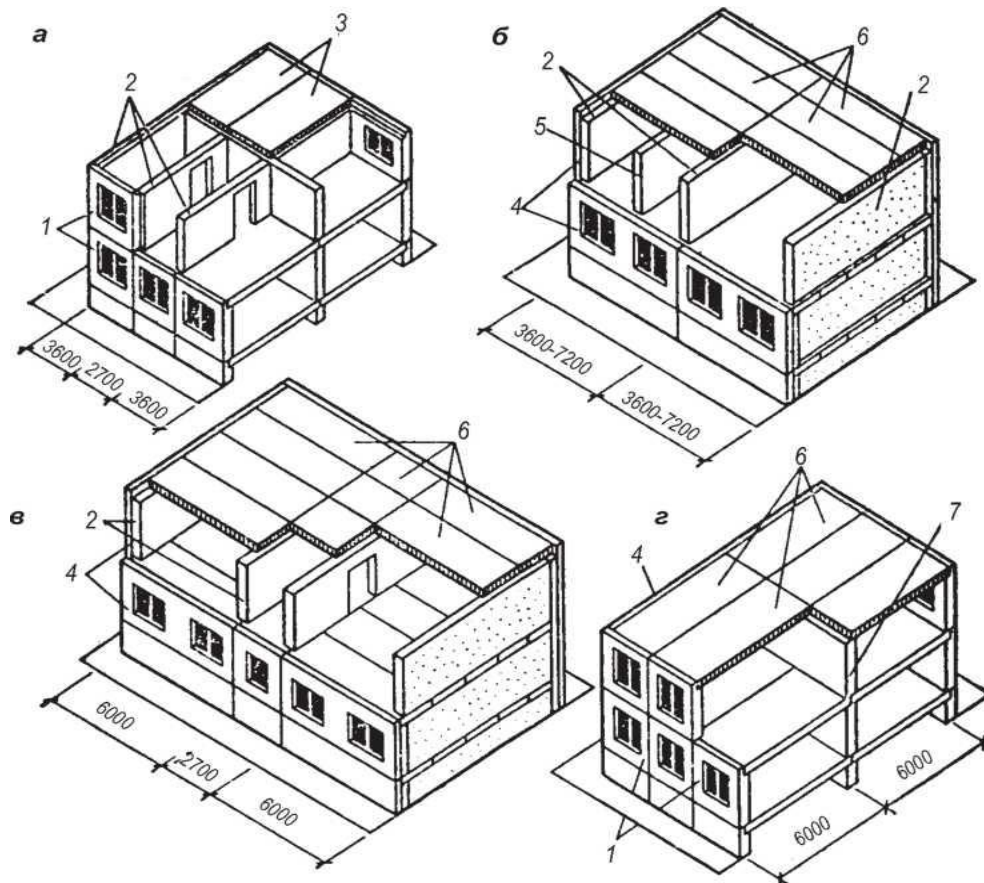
Конструктивні схеми безкаркасних великопанельних будівель: а – з малим кроком несучих поперечних стін; б – з великим кроком несучих поперечних стін; в – зі змішаним кроком несучих поперечних стін; г – з поздовжніми несучими стінами; 1 – несучі зовнішні стіни; 2 – несучі панелі поперечних стін; 3 – плити перекриття, що спираються по контуру; 4 – самонесучі зовнішні панелі; 5 – гіпсобетонна перегородка; 6 – плити перекриття
